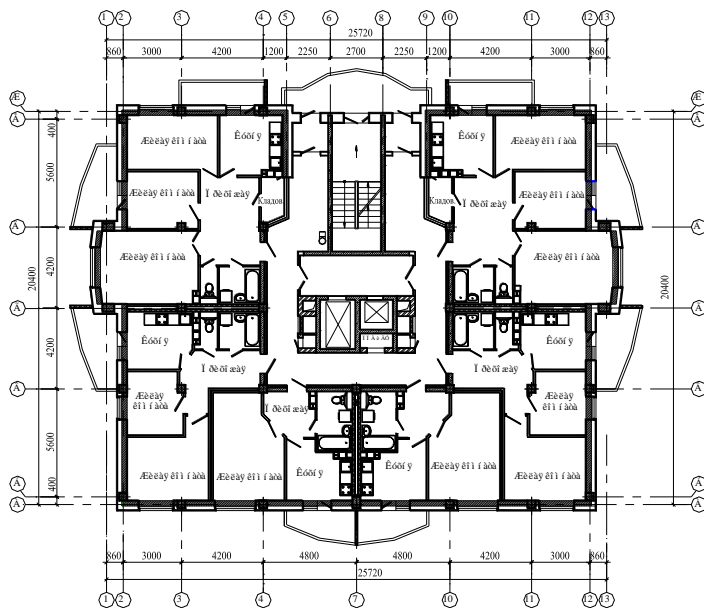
Поэтажный план одноподъездного восемнадцатизэтажного монолитного жилого дома с использованием блоков стеновых с сохранением наружного контура здания
